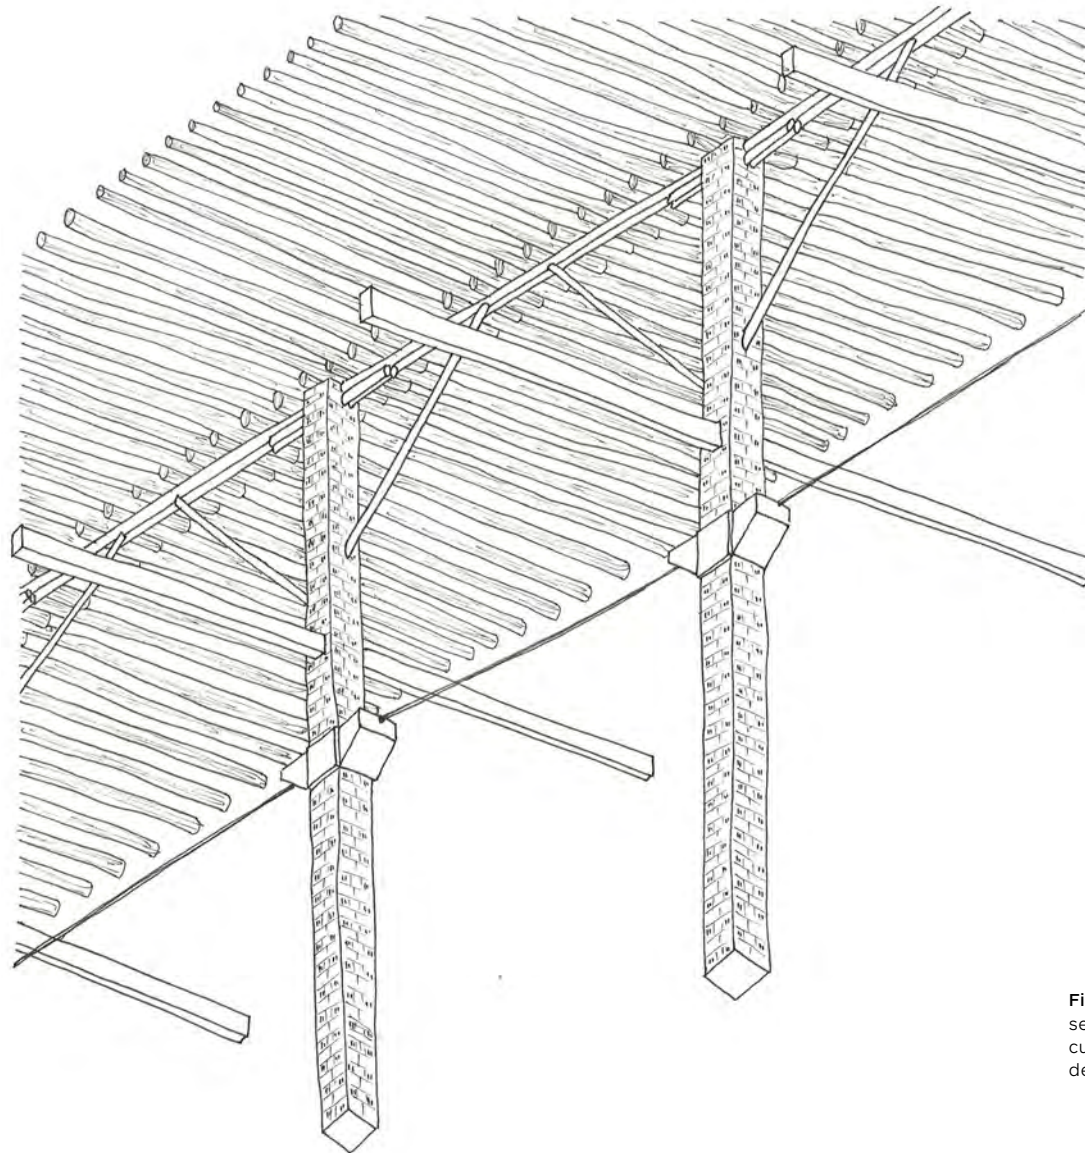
Estructura de secadero de ladrillo con cubierta de madera y vigas de hormigón.
